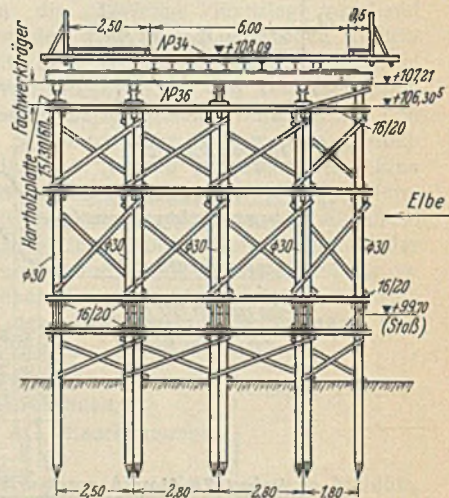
Längsschnitt durch Joch 5 der Behelfsbrücke.
